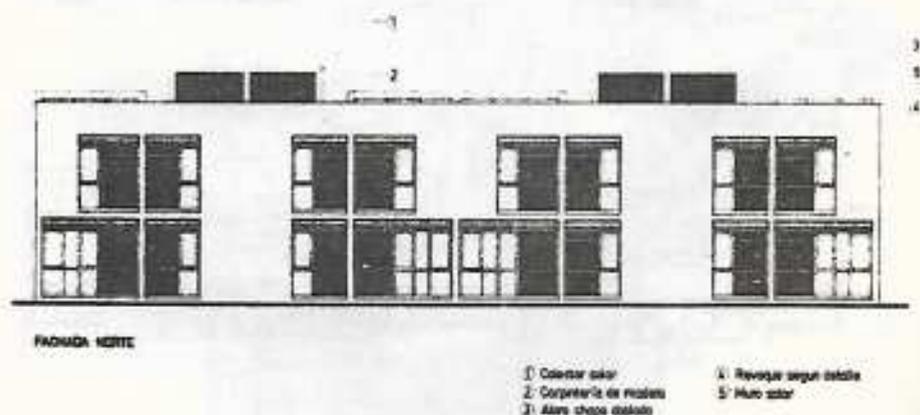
Fachadas norte de viviendas de 4 dormitorios con muro solar
